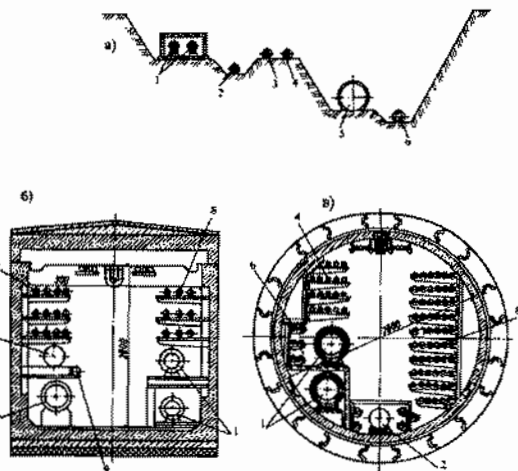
Совмещенная прокладка трубопроводов: а - в одной траншее; б - в проходном канале прямоугольного сечения; в - то же, круглого сечения; 1 - теплотрасса; 2 - водопровод; 3 - газопровод среднего давления; 4 - то же, низкого давления; 5 - водосток; 6 - канализация; 7 - электрокабель; 8 - телефонные кабели; 9 - электрокабели специального назначения
